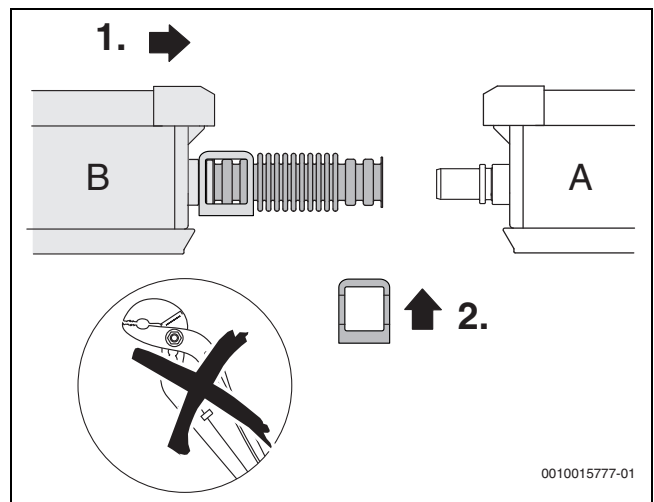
Colocar el colector izquierdo junto al colector derecho
